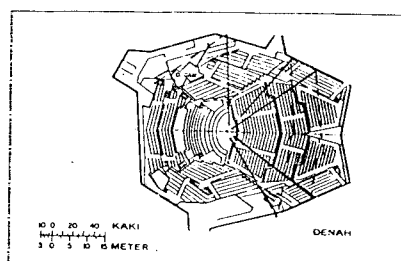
Bentuk ruang kipas (fan shape).
